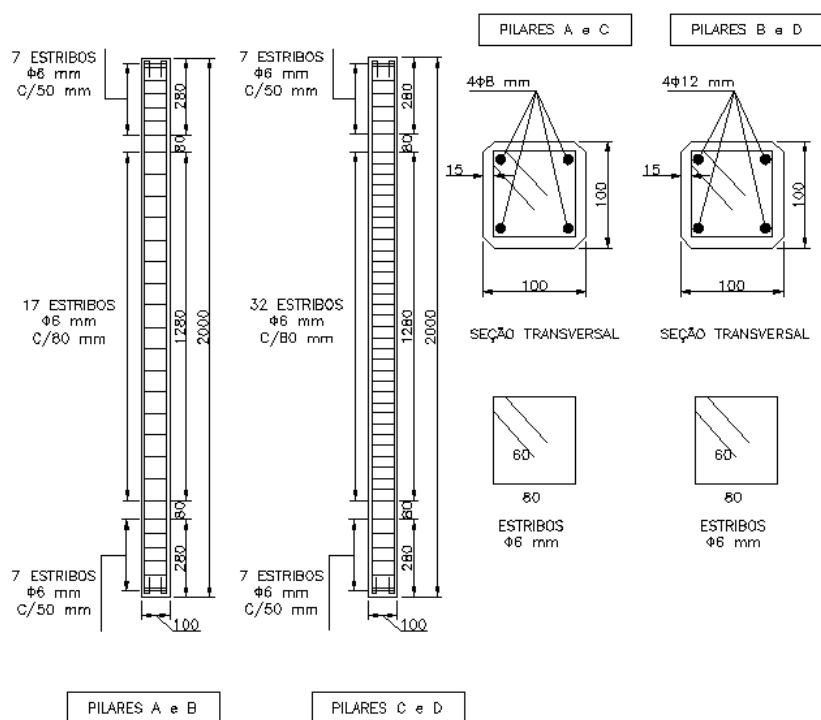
Geometria e detalhamento da armadura – GALANO e VIGNOLI (2008)
